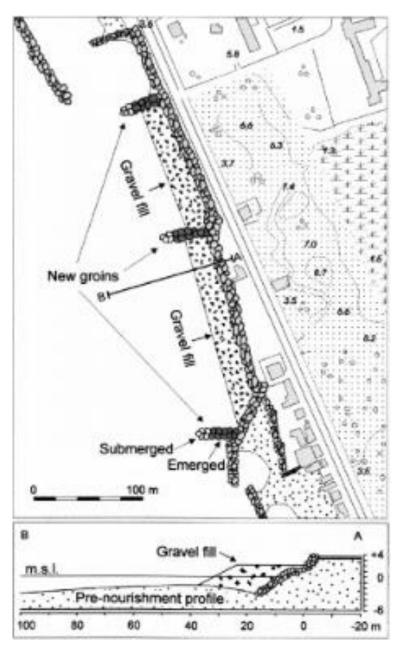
vue en coupe et en plan du secteur réorganisé lors des travaux de l'hiver 2001-2002
